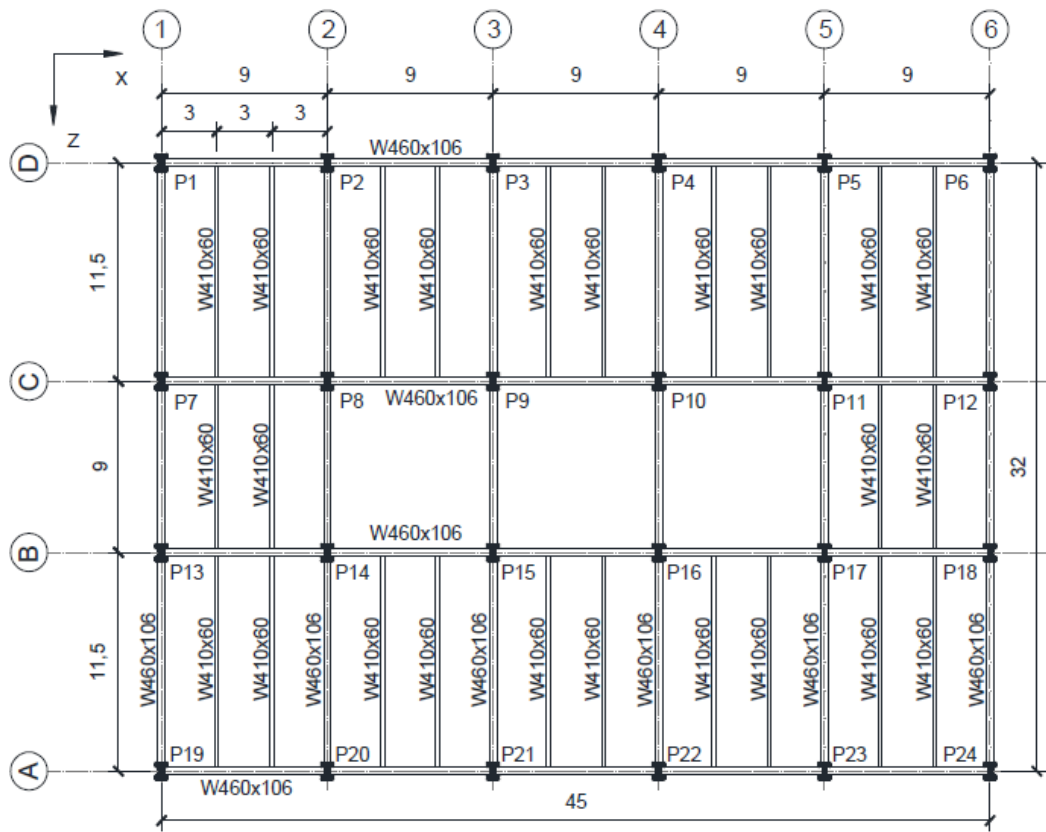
Planta baixa do pavimento tipo do Modelo 173 m (RIOS, 2015).
